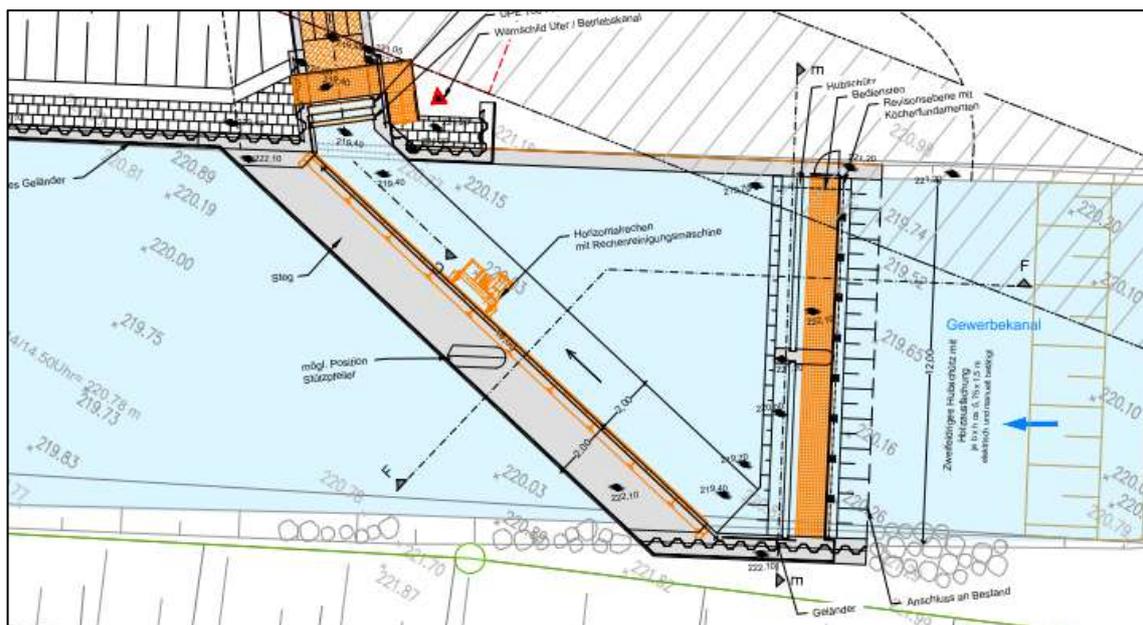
geplante Fischschutzanlage mit Horizontalrechen (Draufsicht)
